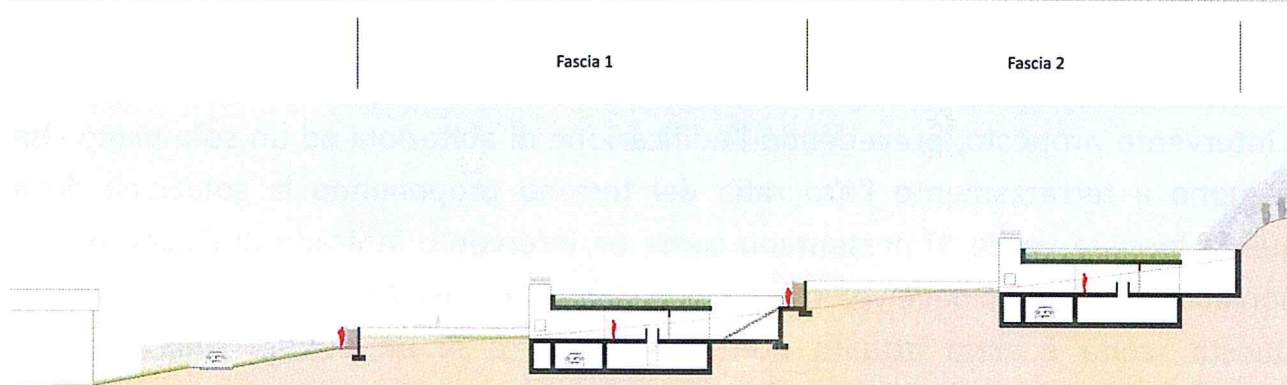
Sezione trasversale - stato di progetto - con orientamento solare.
